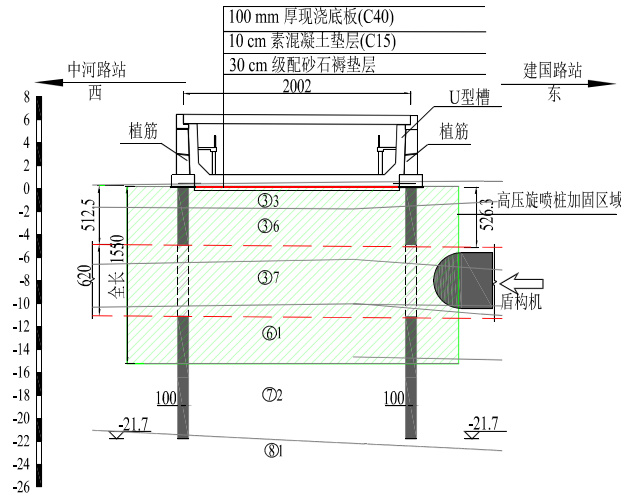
盾构隧道穿越桥梁桩基立面图 (加固后) 1:150 (单位: cm)
